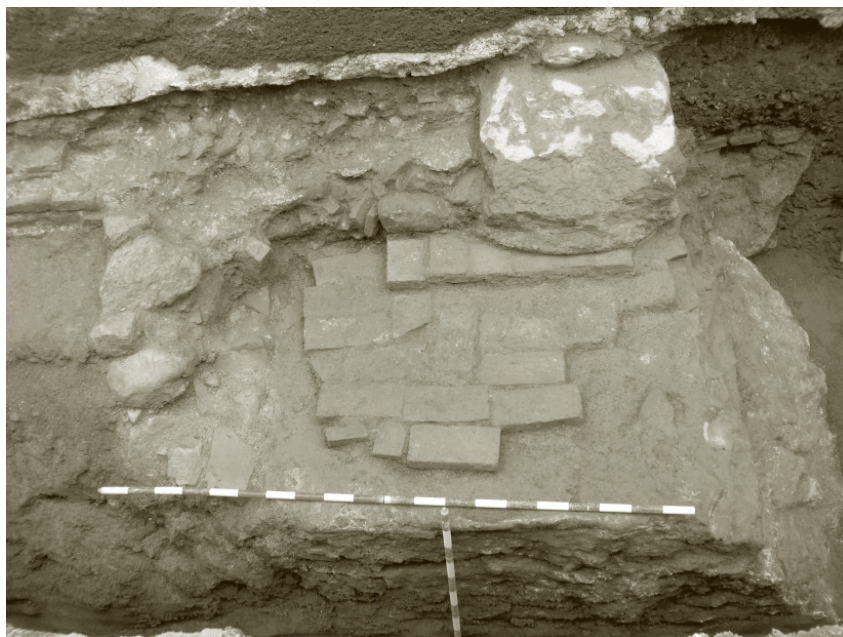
Estribo norte de la primitiva fábrica de las Atarazanas (fachada oeste) con pavimentación de época nazarí (siglo XIV)
